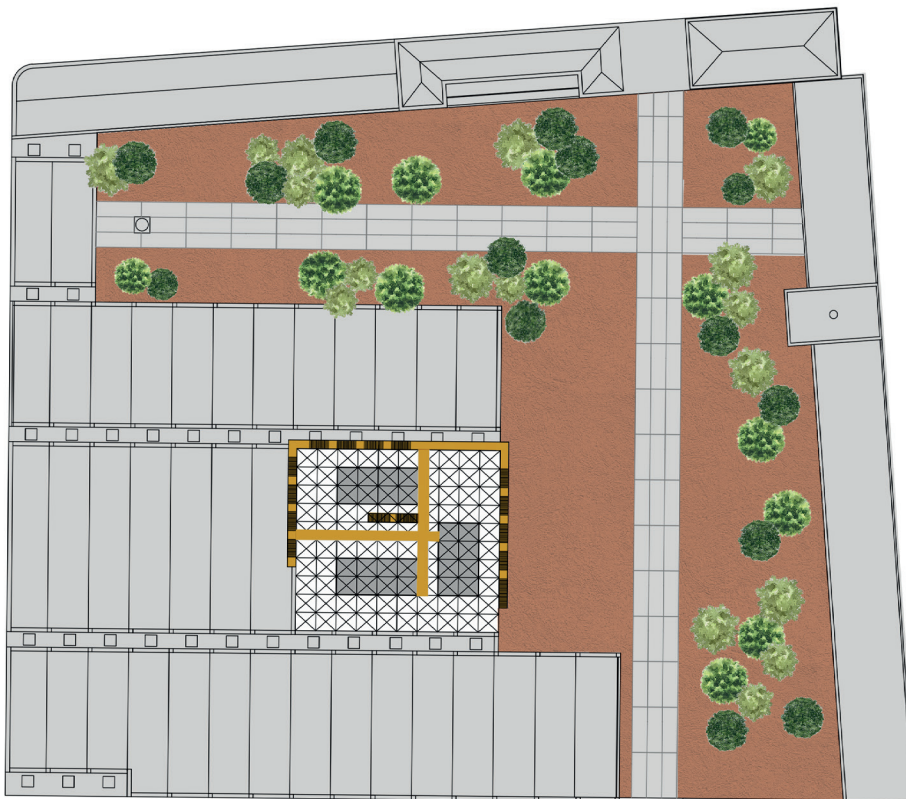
Planta da Cobertura da Fábrica Barros. Realizado em CAD pela autora.
